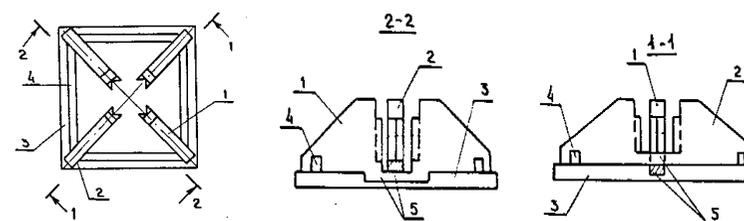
Сборно – монолитный фундамент Фсм – 2
